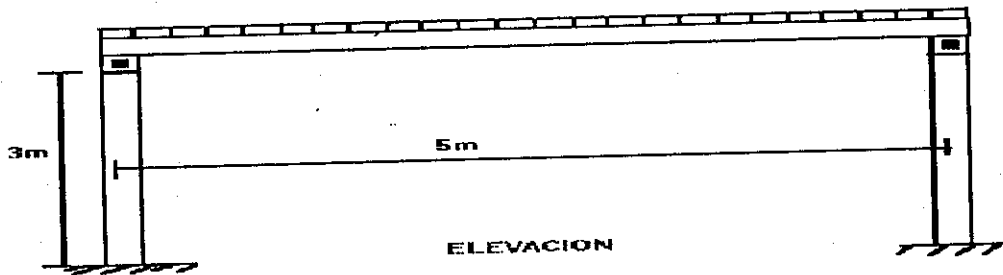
ELEVACION ESTRUCTURA DE MADERA (Sin escala)
